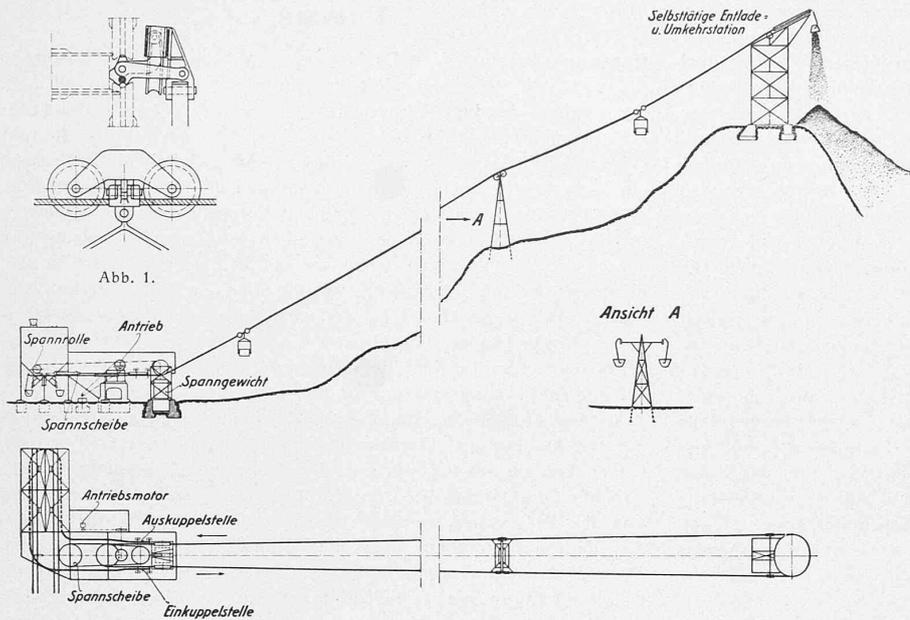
Grundriss und Längsprofil einer als Einseilbahn ausgeführten Haldenabsturzbahn.
